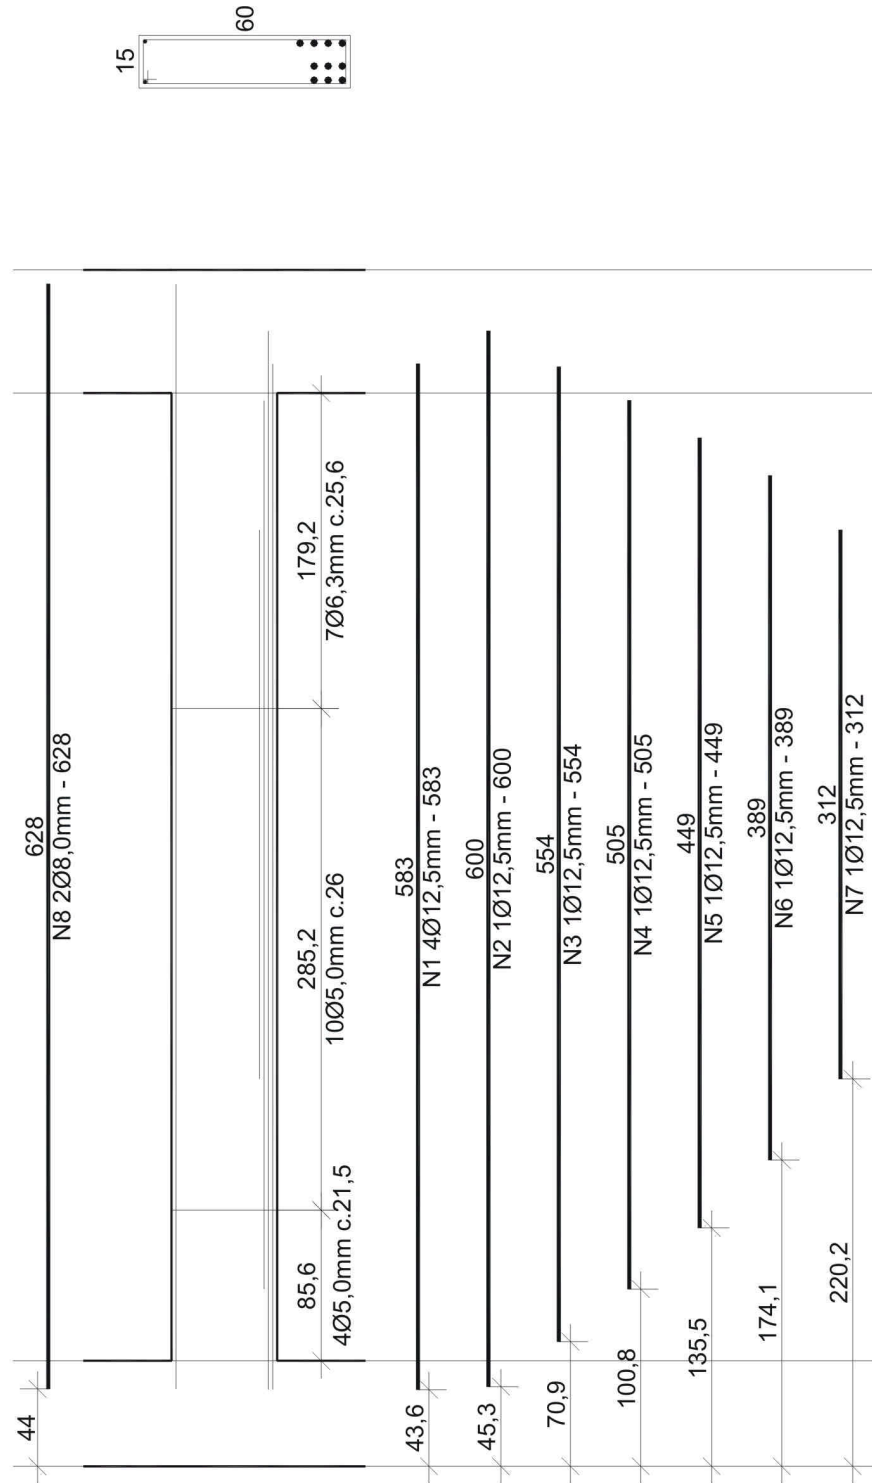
Detalhamento Viga 02, realizado pelo VigaCalc.
